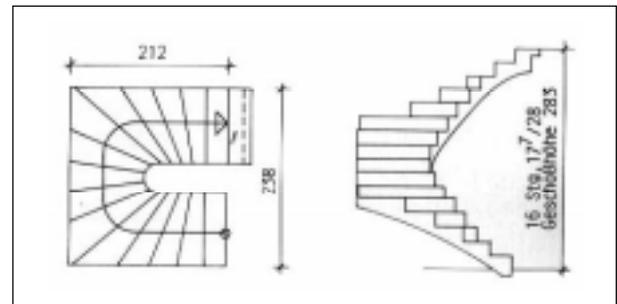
Gewinkelte Stahlbetonfertigteilstiege mit halbge-wandeltem Zwischenteil
